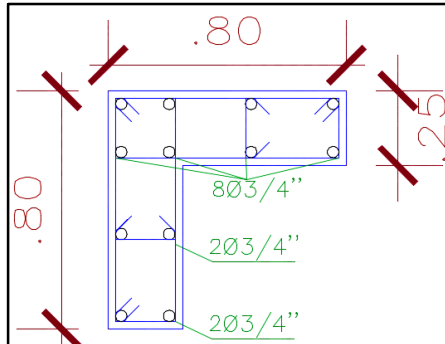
Detallado de acero de la columna "B3" – Sistema aporticado
